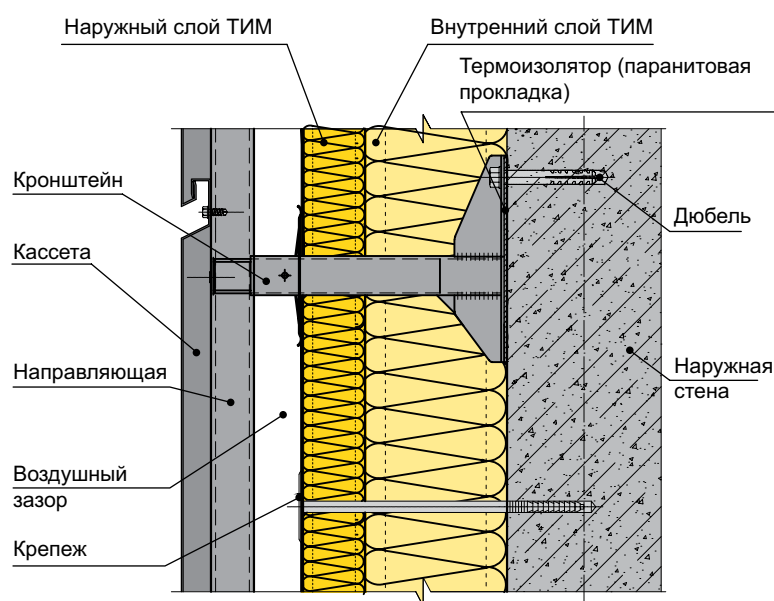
Схема теплоизоляции вентилируемого фасада. Двухслойное решение
